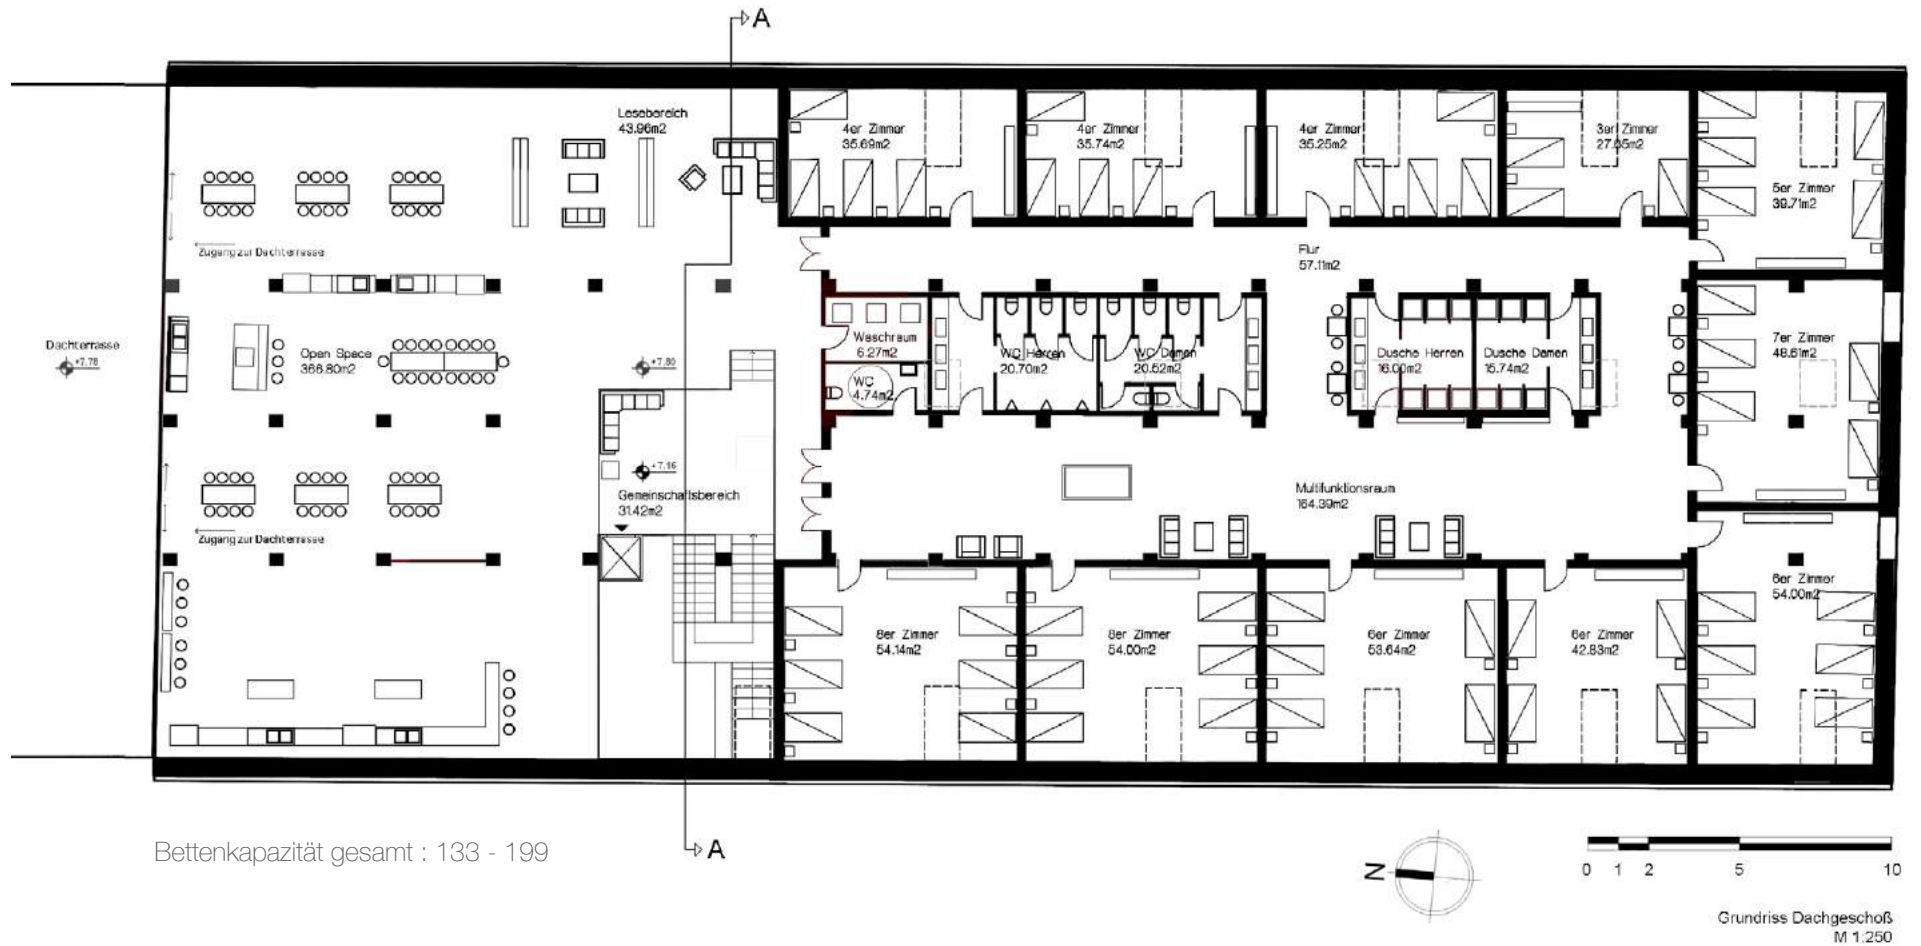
Dachgeschoß; Hostel im Ostkavalier
